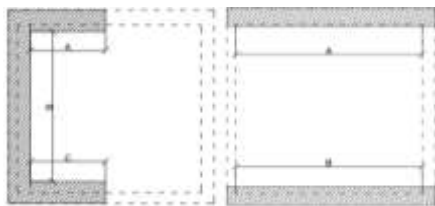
Приклади розташування стін, що опираються на фундамент.
